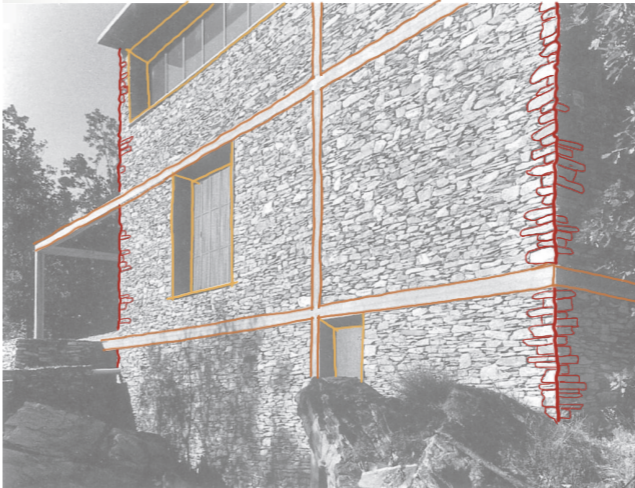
y 39: La estructura de hormigón no es visible en las esquinas, sin embargo, aparece para dividir el cerramiento de mampostería en cuadrantes.
